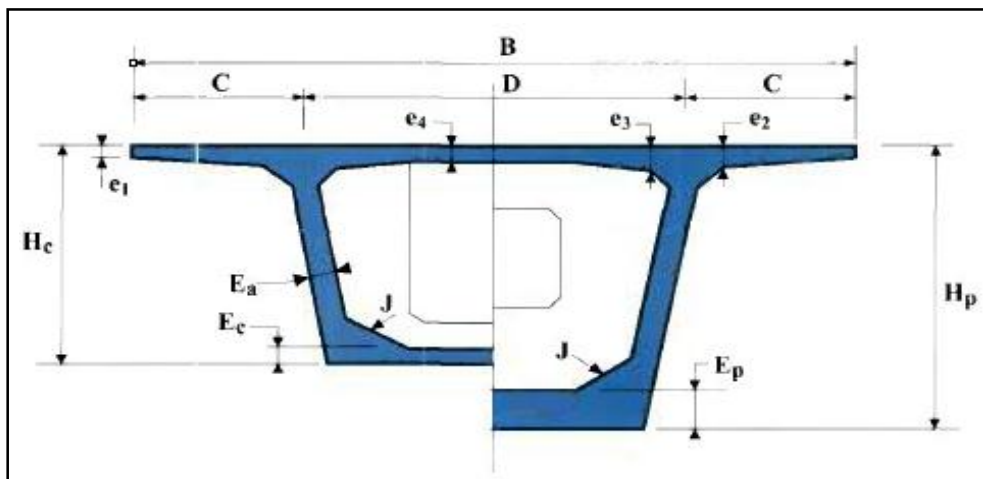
coupe transversale du voussoir type pour pré-dimensionnement [13]
